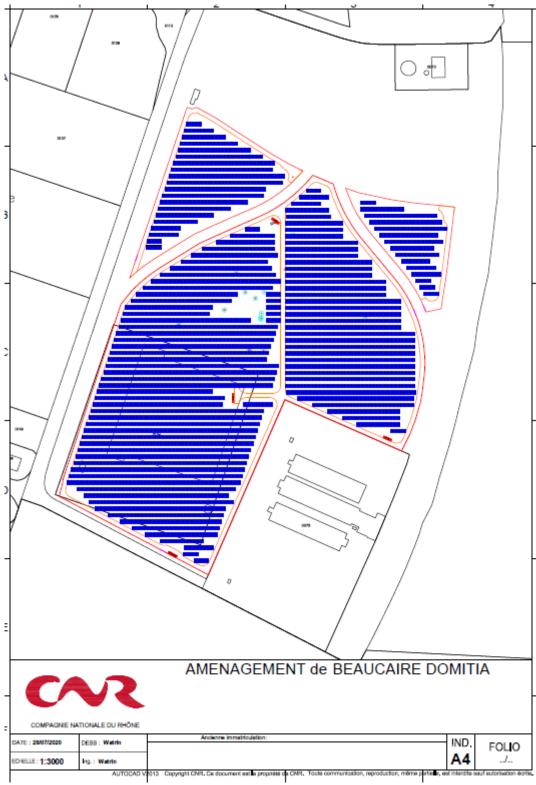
Plan de masse de la variante 1 (juillet 2020)
